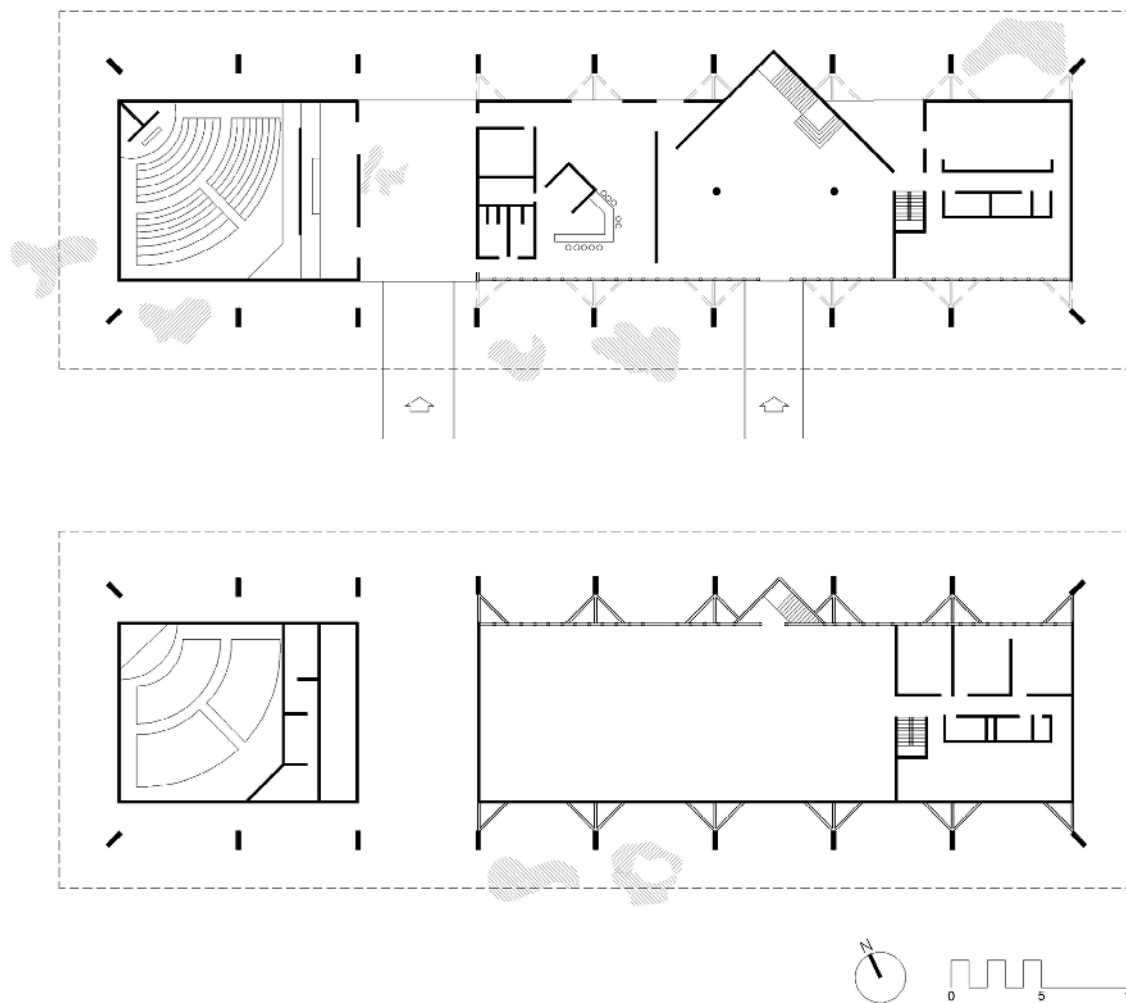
Planta baixa do pavimento térreo e superior do Museu da Restauração.
